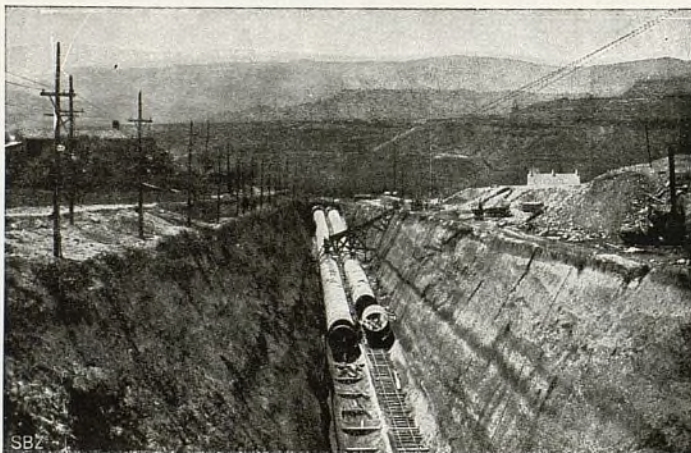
Montaje de la tubería; preparativos para el macizado que sigue a la colocación de tubería a unos 30 metros de distancia.
